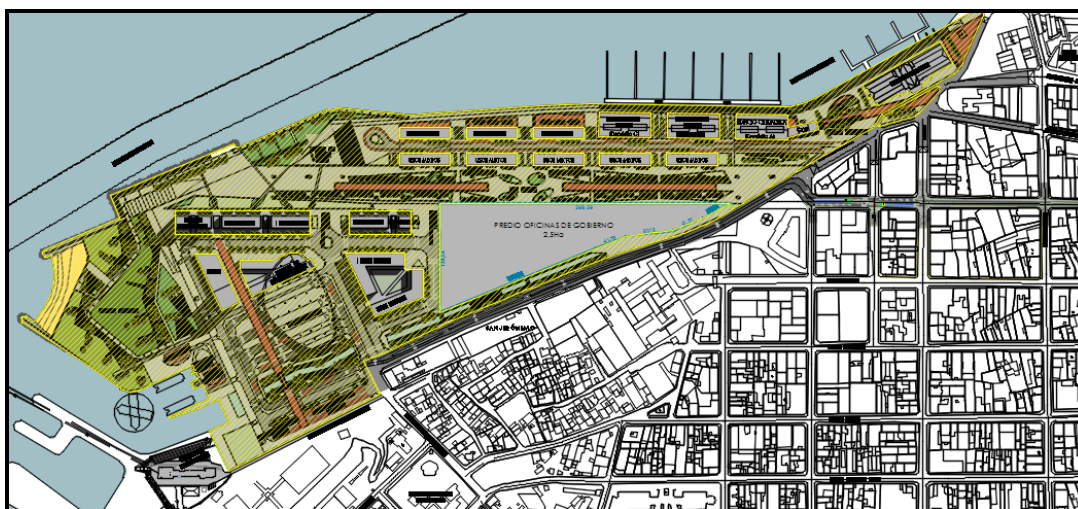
Vista del sector para Oficinas de Gobierno de acuerdo al Plan Maestro.
